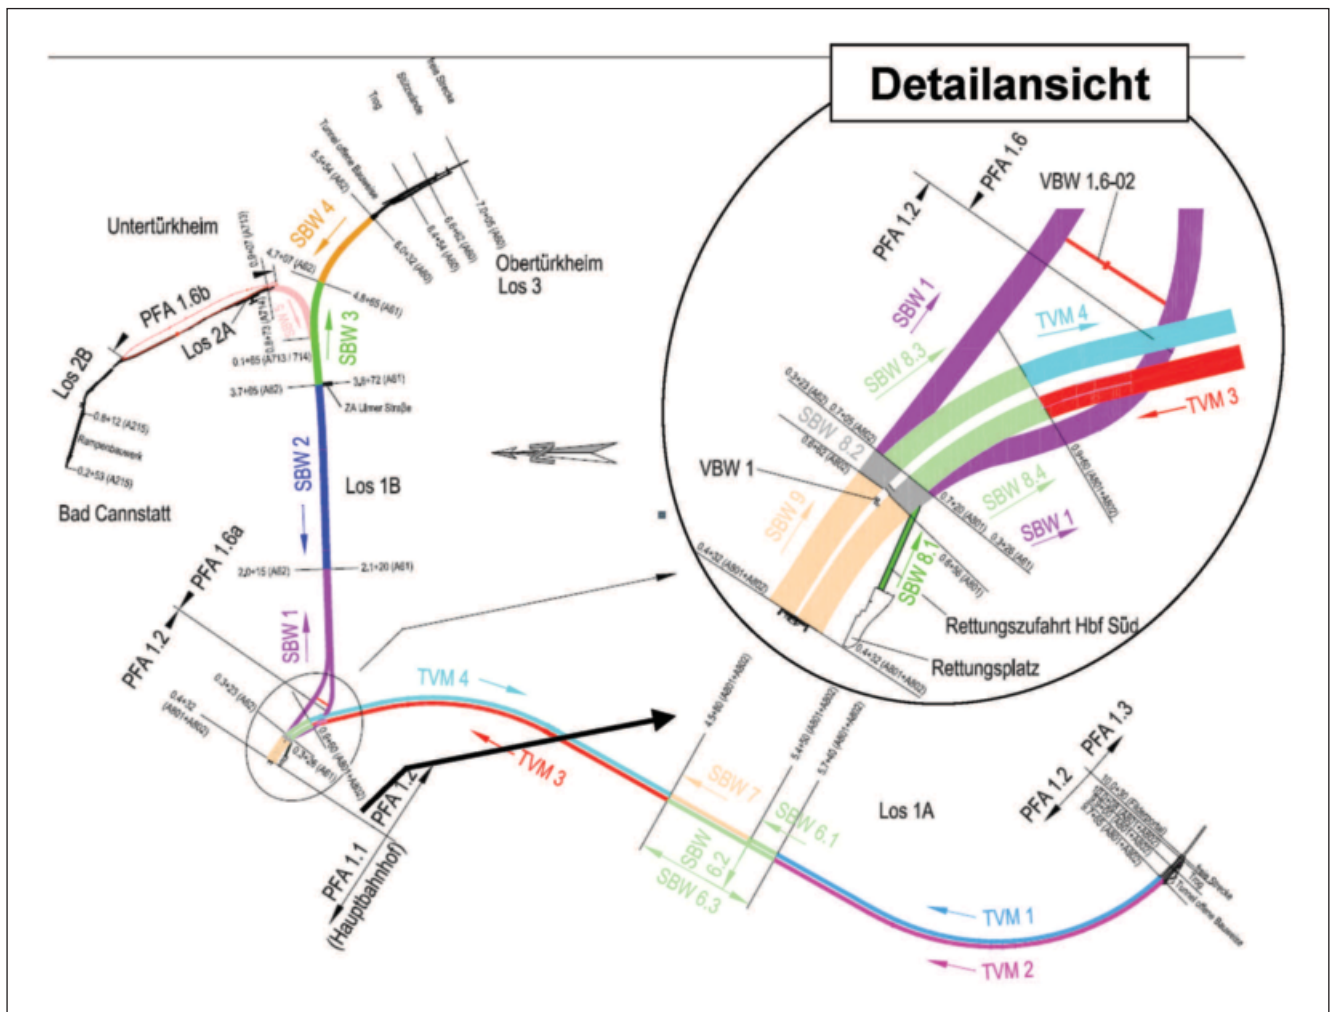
Vortriebsszenario: Planfeststellungsabschnitte (Pfa) 1.2 (Fildertunnel) und Pfa 1.6a (Zuführung Ober-/Untertürkheim)
